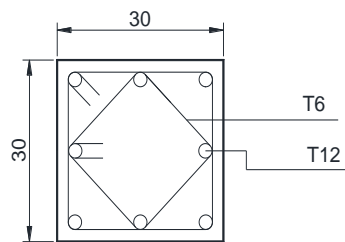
Ferrailage d'un poteau 30x30cm (poutres noyées - plan légèrement irrégulier)
